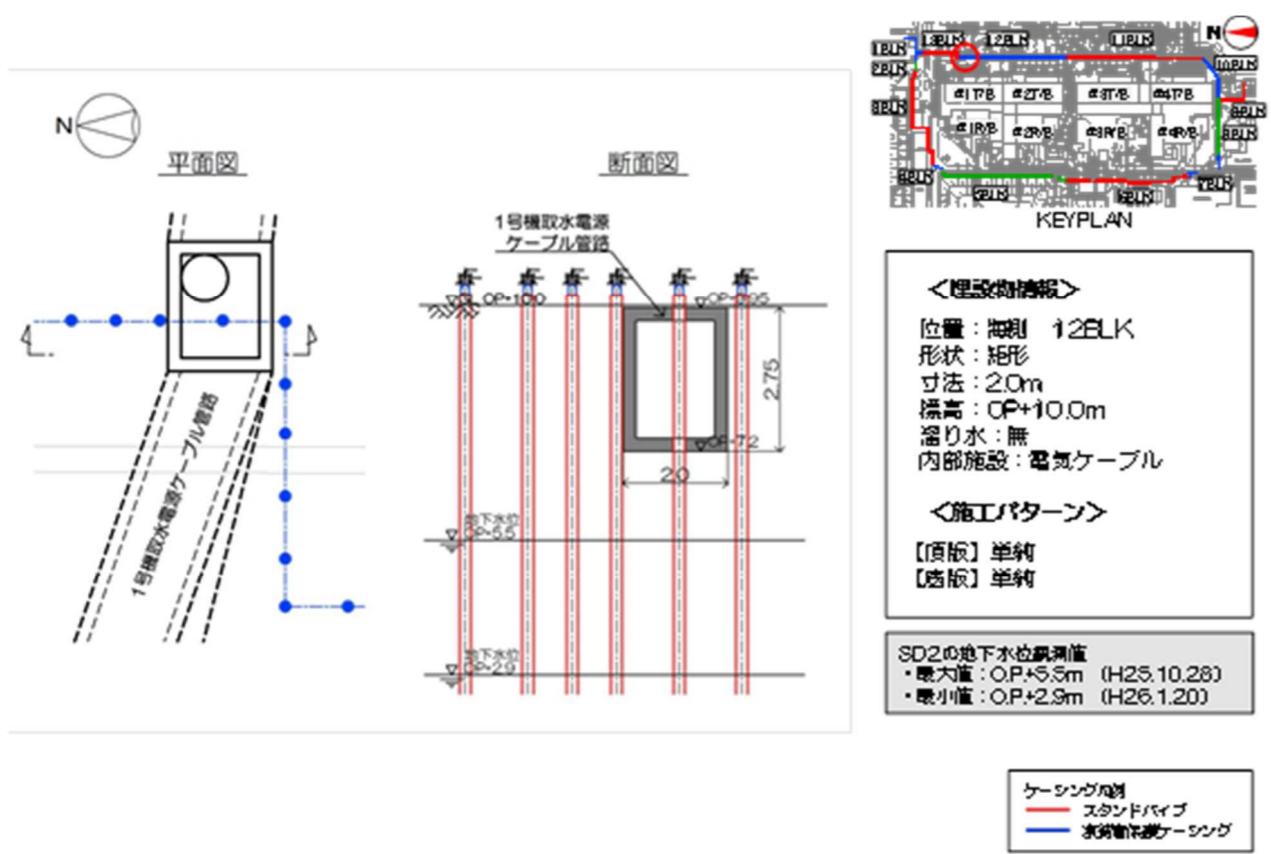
【12-10】1号機取水電源ケーブル管路 施工方法 (貫通施工)
